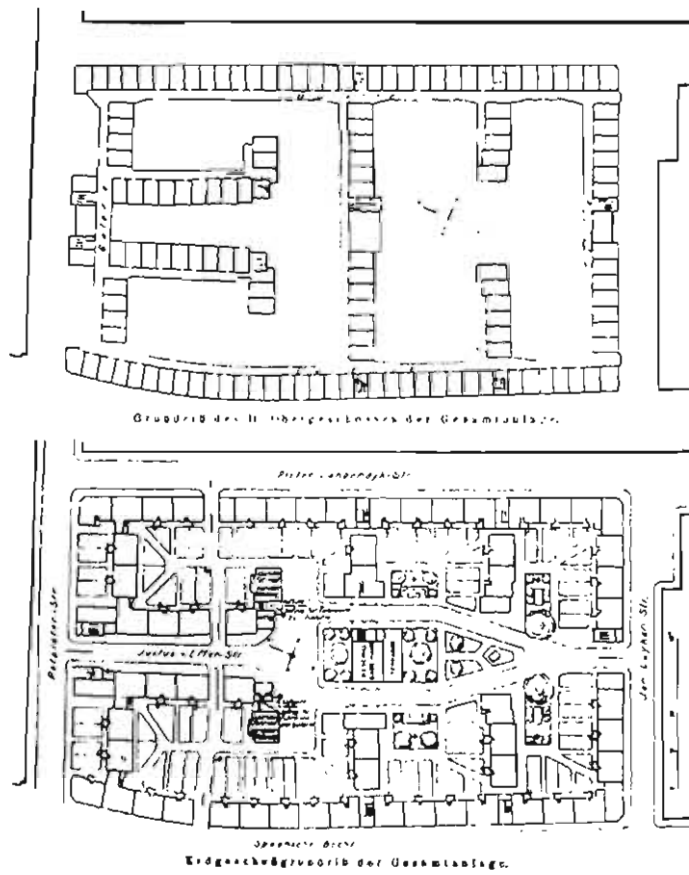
Wohnblock von Michel Brinkman, Grundriß des Erdgeschosses und des zweiten Obergeschosses (mit offener Erschließungsgalerie)
